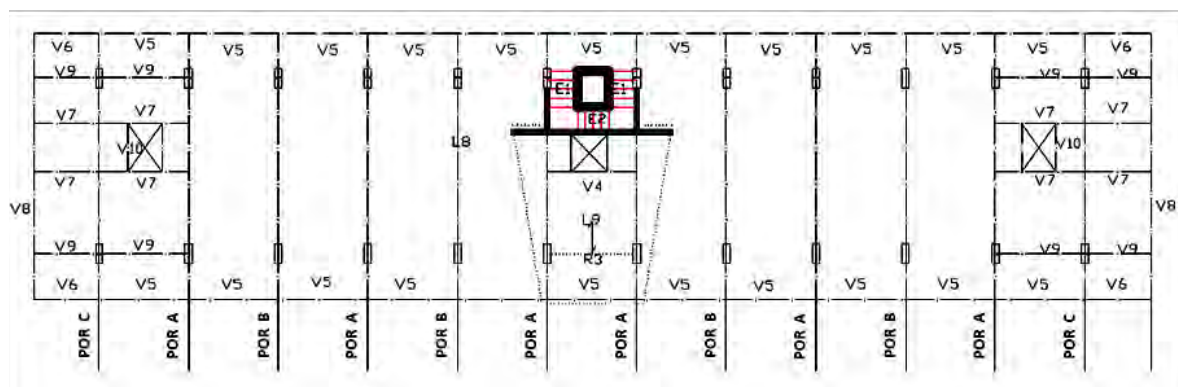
Planta estrutural do R/C (piso de entrada).
